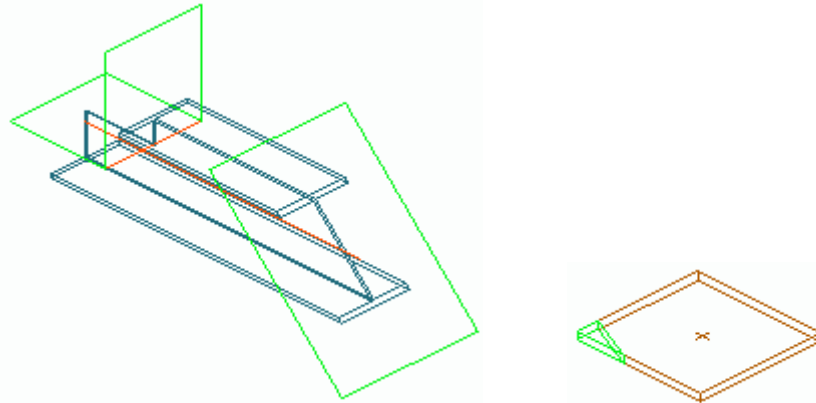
Grugeage d'une poutre, et chanfreinage d'un plat
